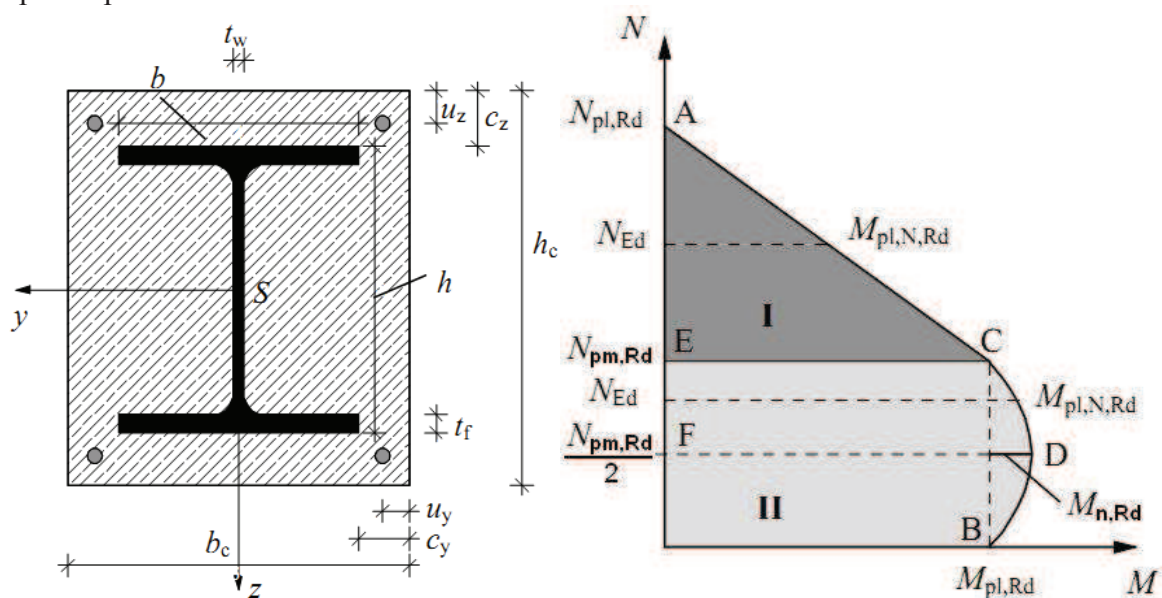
Переріз сталезалізобетонної колони у вигляді повністю обетонованого сталевго двотавра (ліворуч); наближення для кривої взаємодії між згинальним моментом і поздовжньою силою (праворуч)
